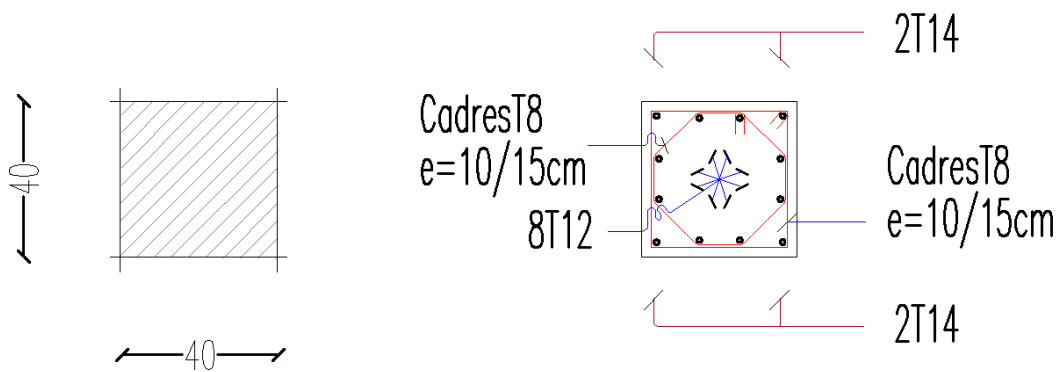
Schéma de ferrailage des poteaux 40x40
